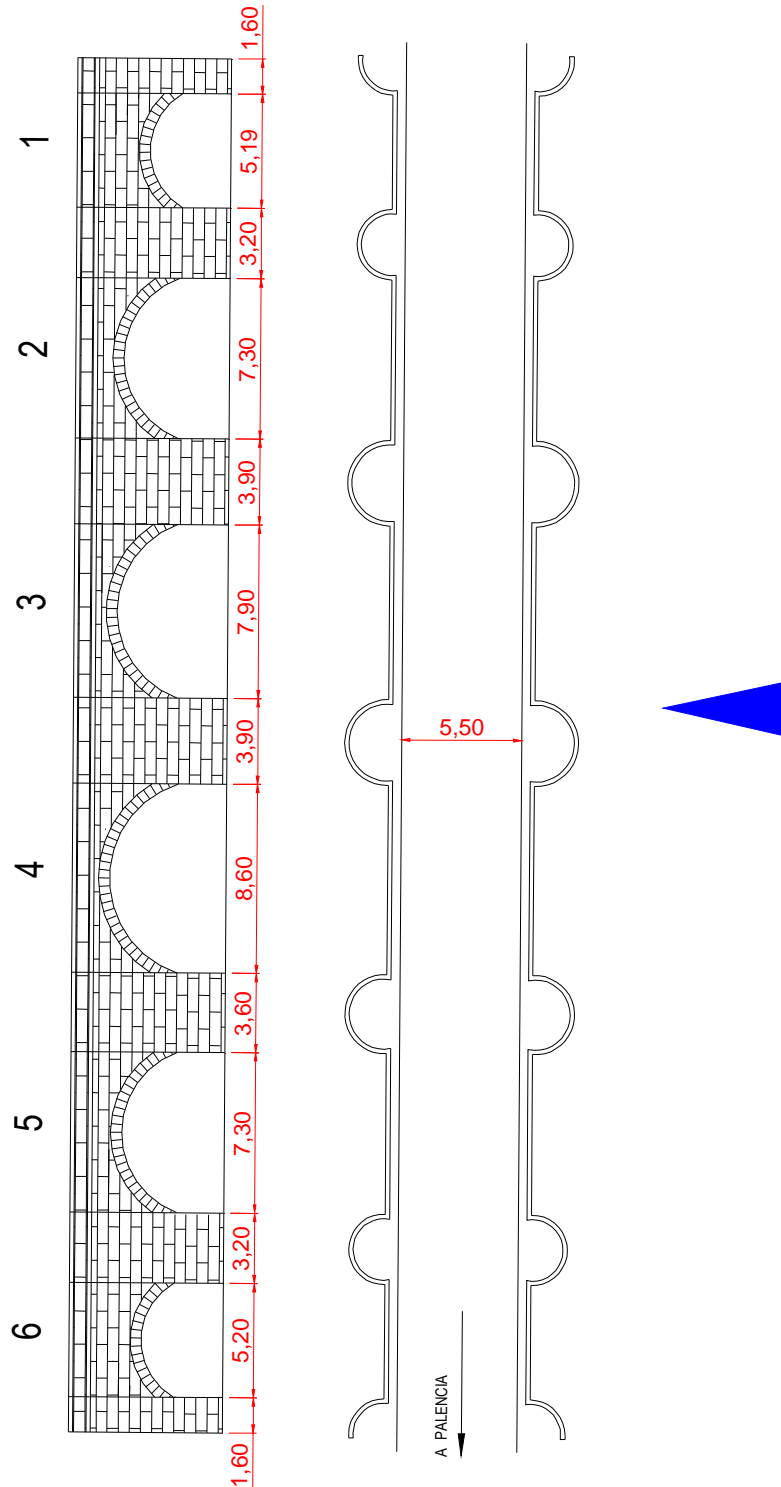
Planta y alzado de aguas arriba del puente de Don Guarín
